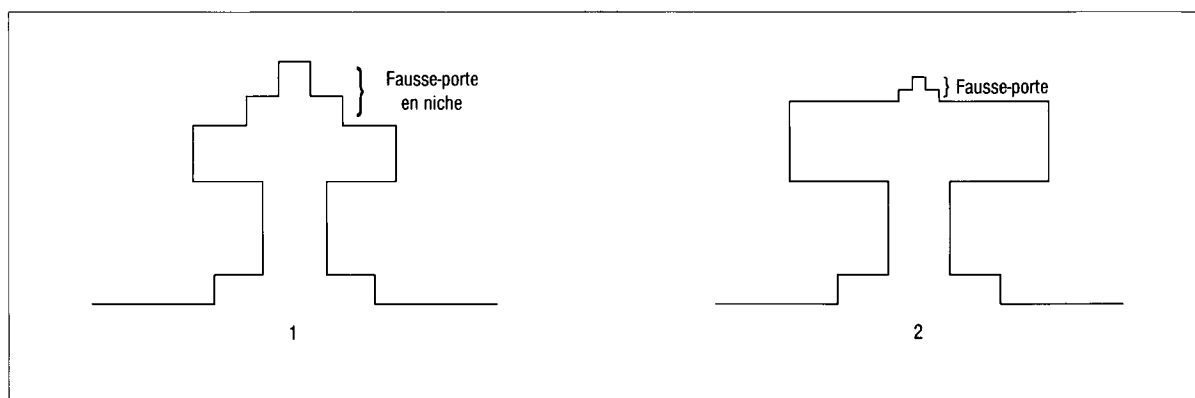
Chapelles de plan cruciforme, type et modifié.
